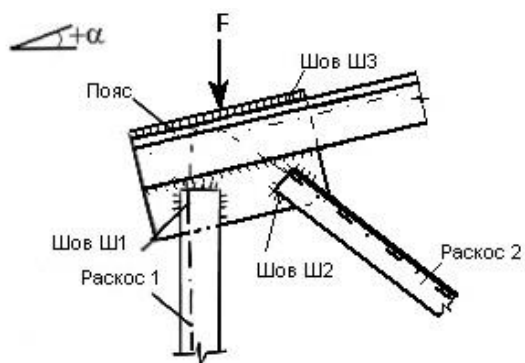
«Конструкторский чертеж узла номер 8» [10]
